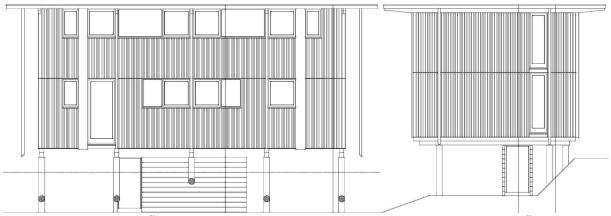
ELEVAÇÃO POSTERIOR CASA-TIPO 2 (VILA TAGUAÍ). FONTE: ITA (2011)
